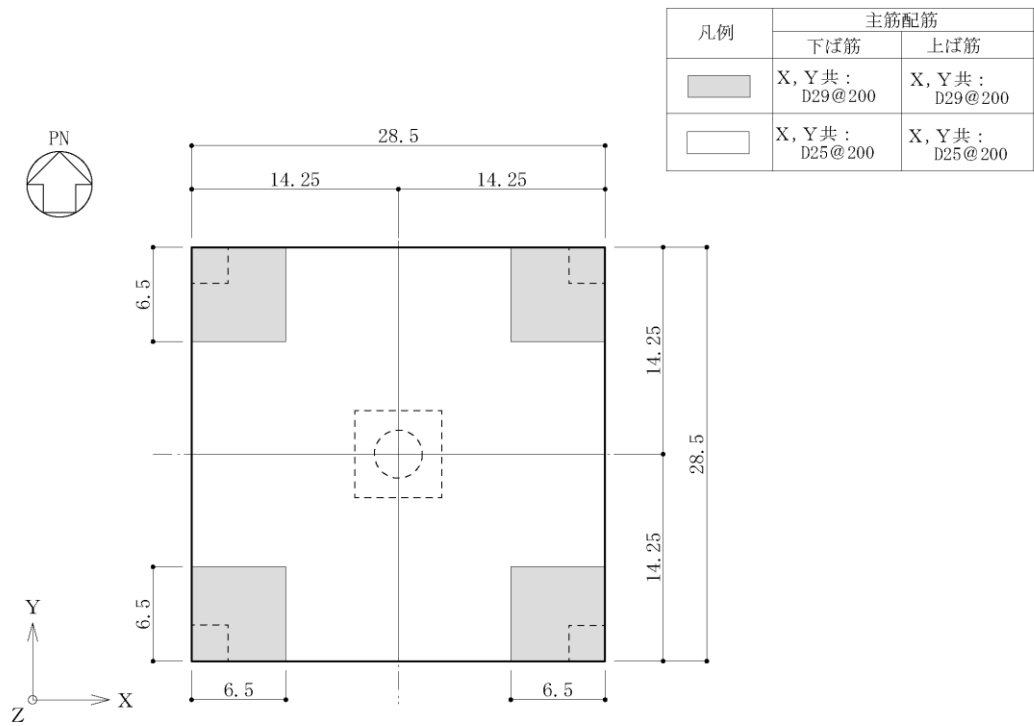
(1) 基礎版の概略配筋図（主筋）（単位：m）
